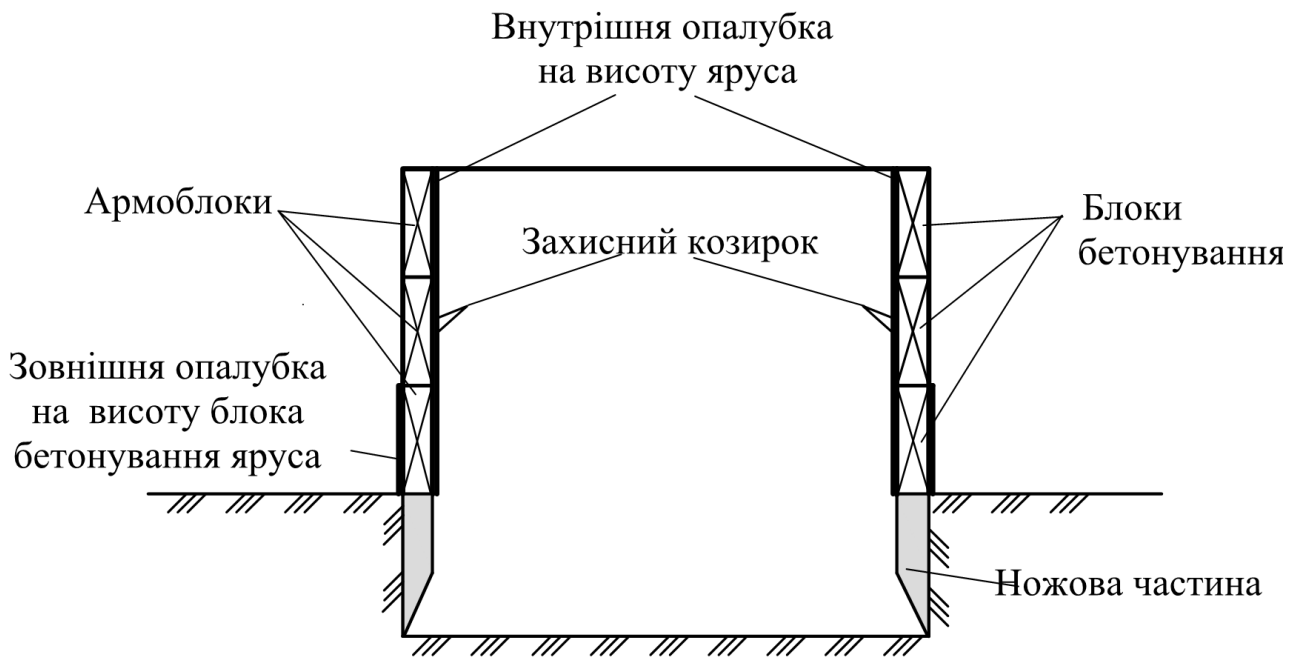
Установка опалубки й арматури ярусу стіни опускного колодязя
